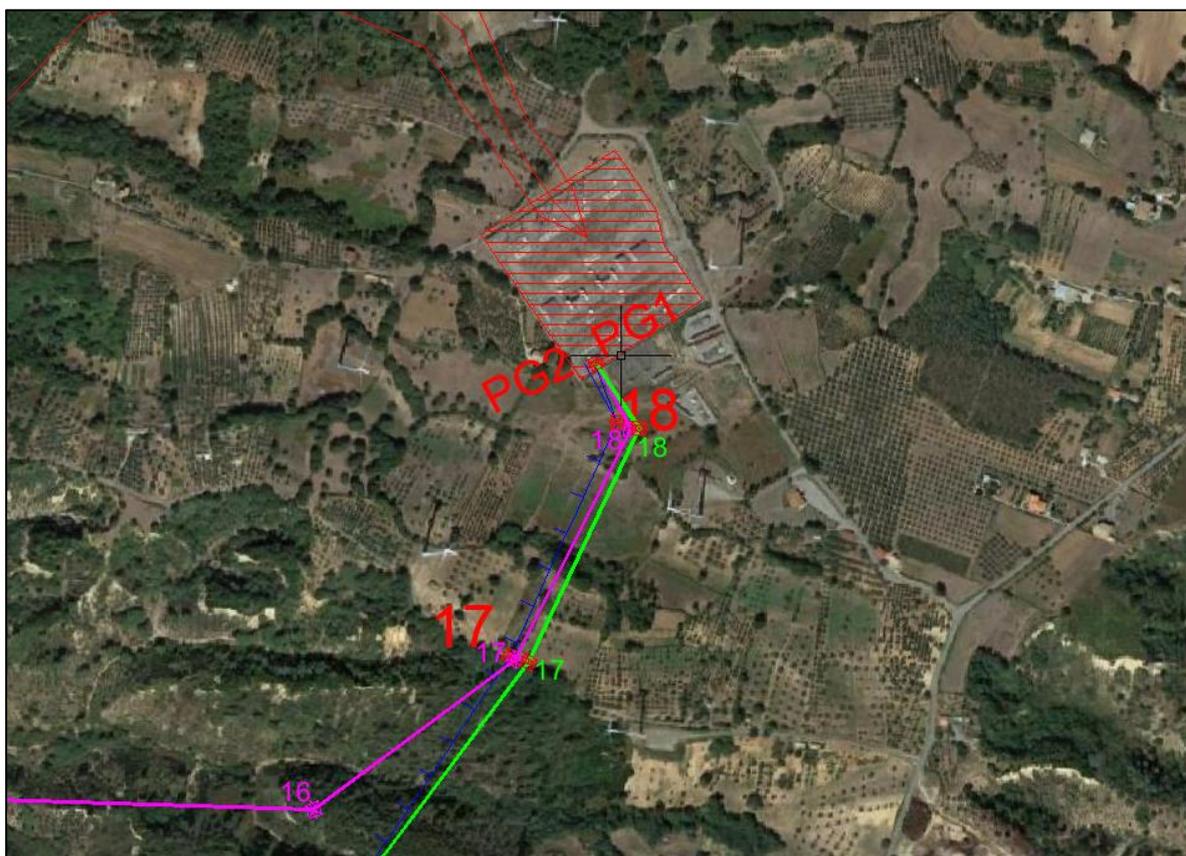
Alternative 1 e 2 rispetto al Tracciato di progetto (Sostegni 17-18)
